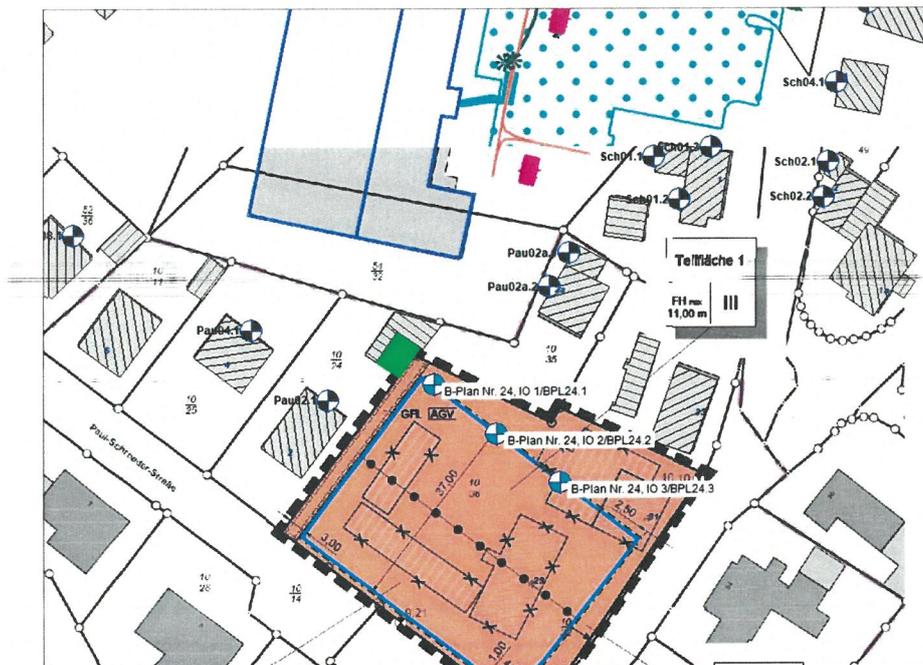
Gewerbelärm, Lage der Immissionsorte im B-Plan Nr. 24
